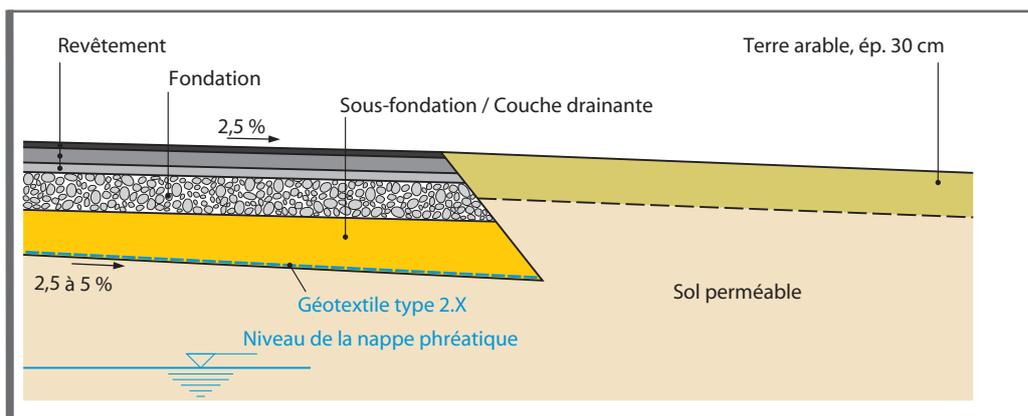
Schéma de couche drainante (cas d'un sol perméable - nappe haute)
